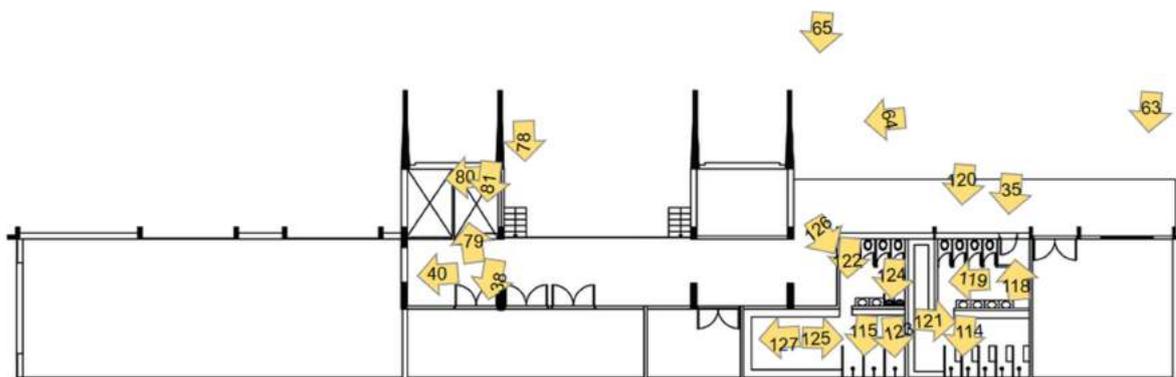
Planta do RU – subsolo – Montagem Autor: Valentim, M. 2020
